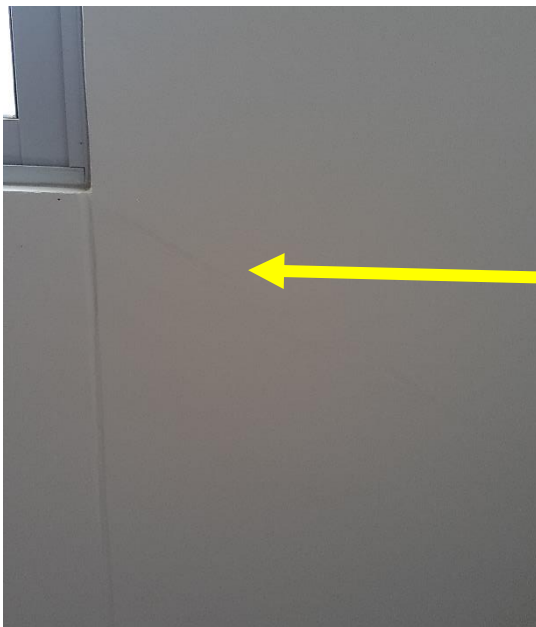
Fisuras en aristas de alfeizar y muro de concreto armado
